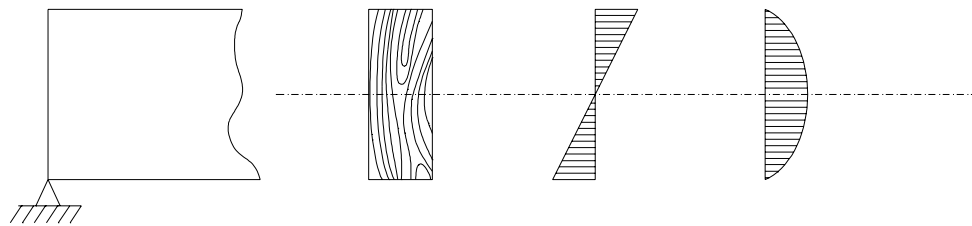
Distribuição de tensões sobre seção transversal de uma viga.
